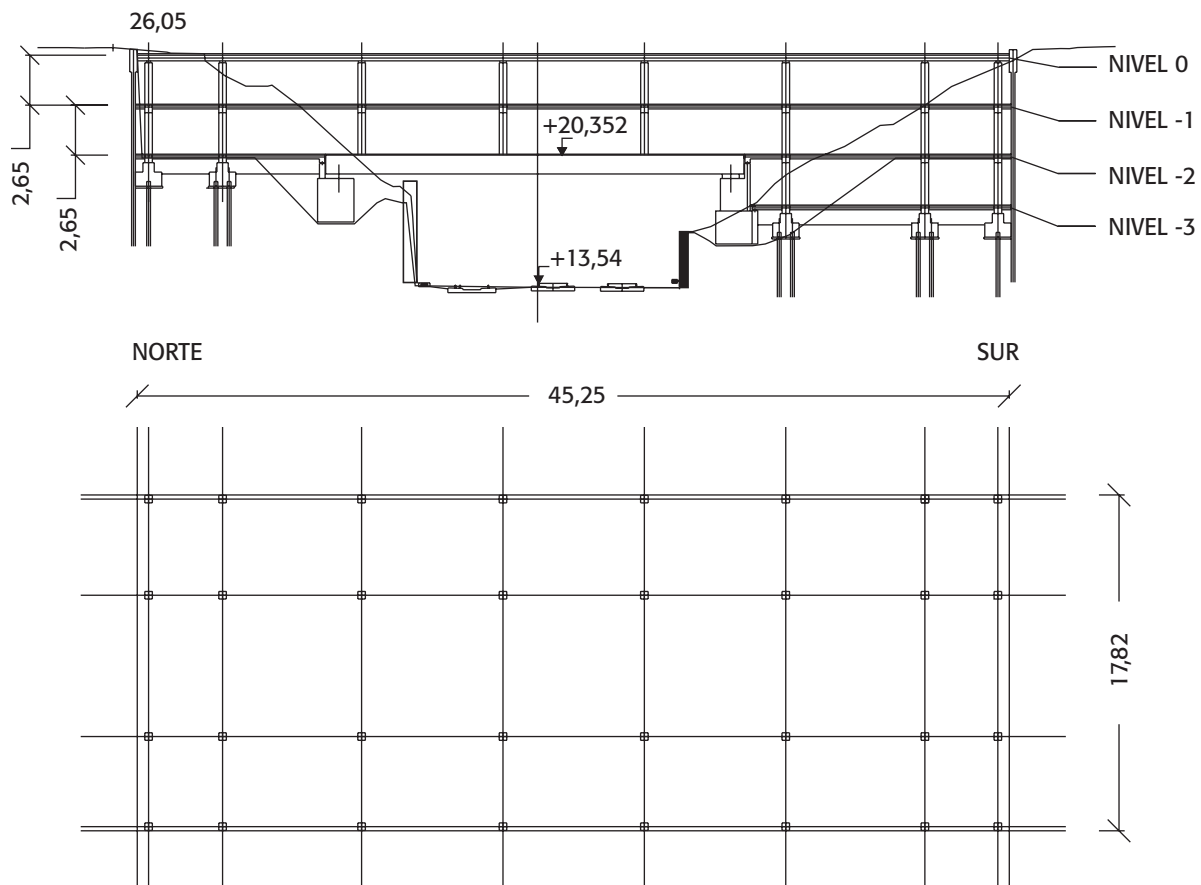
Sección transversal y planta por el nuevo Pont-Vieux
